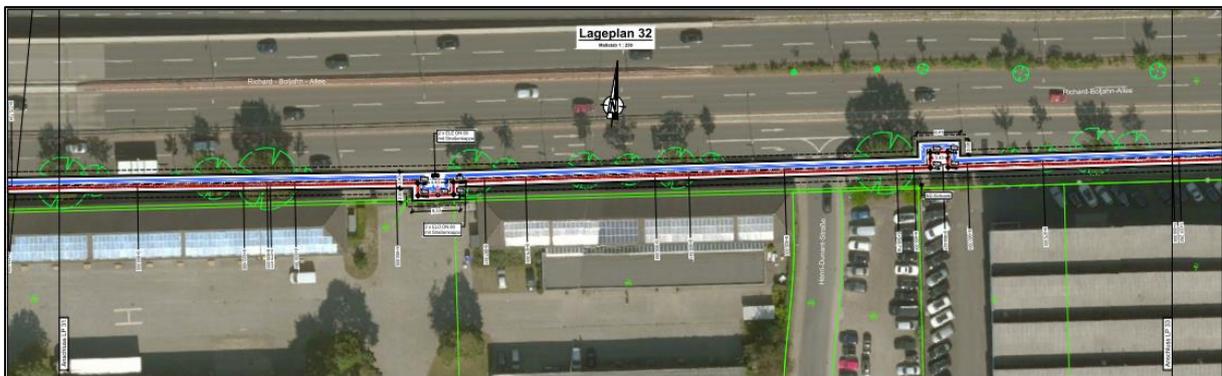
Abschnitt 16 - Richard-Boljahn-Allee Plan 2.2.32
